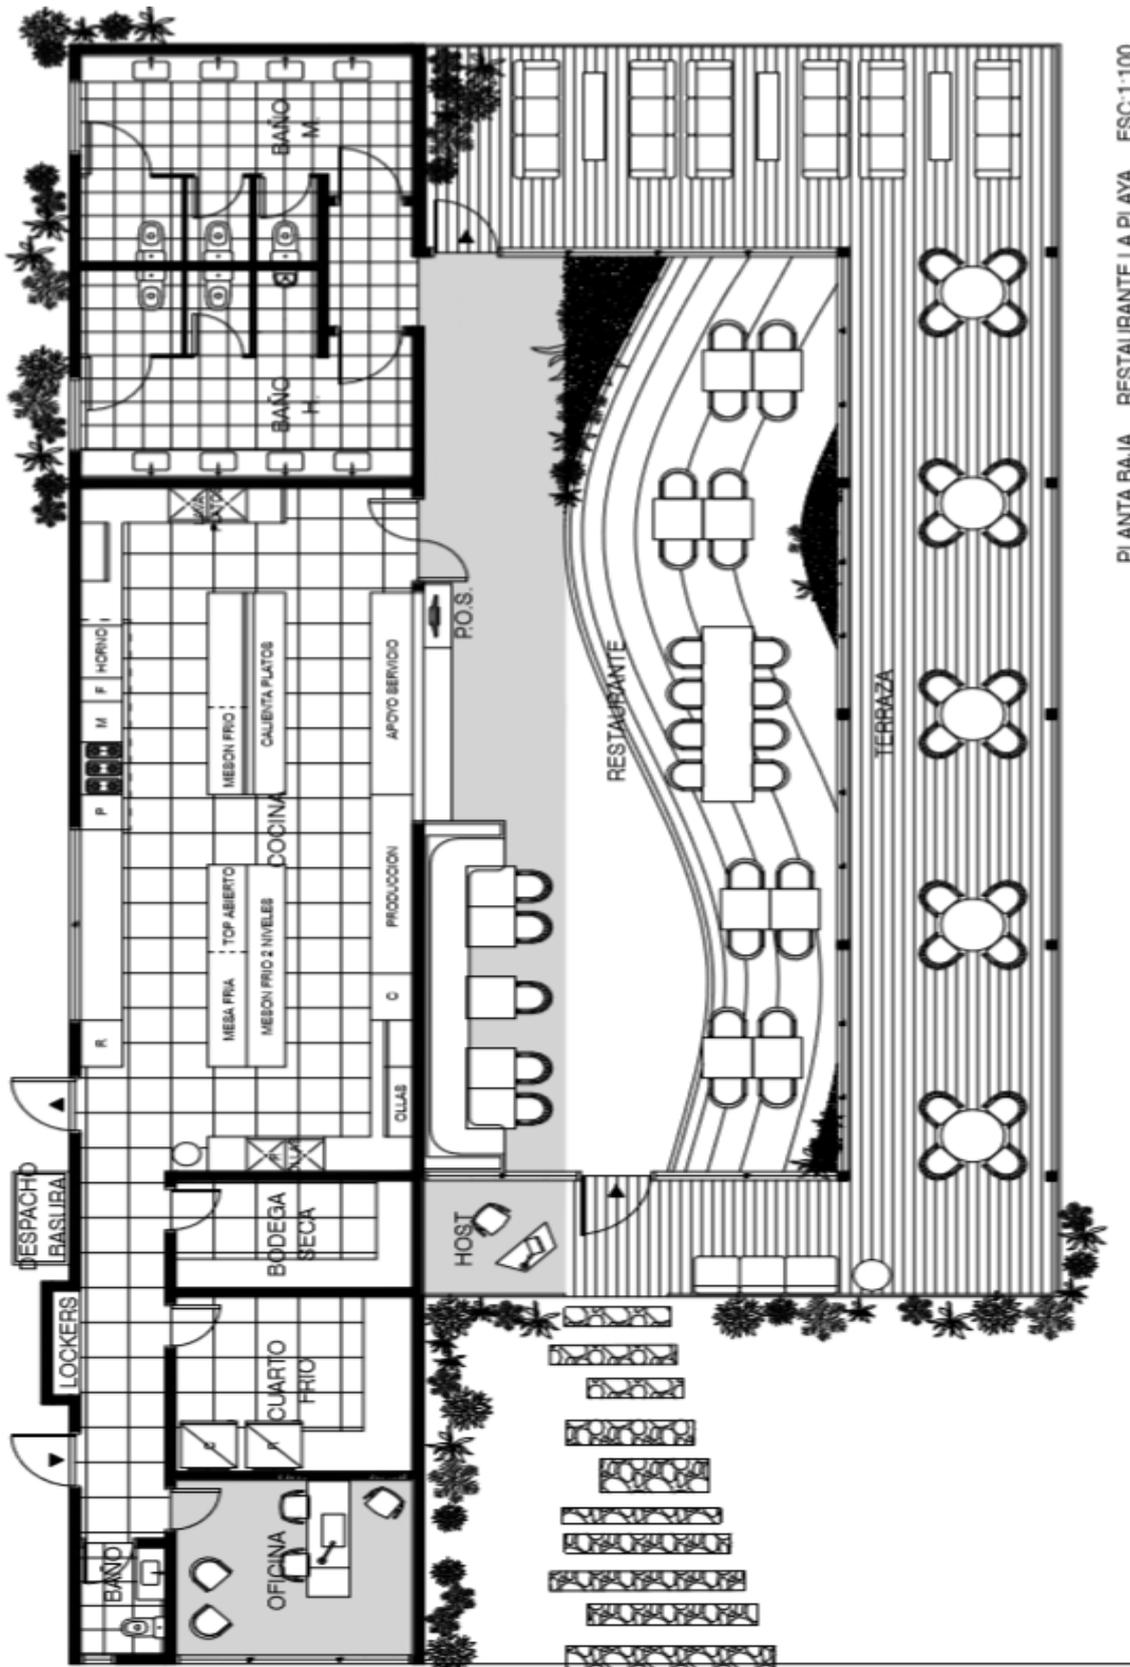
Vista de planta general del proyecto en toda la extensión del terreno
